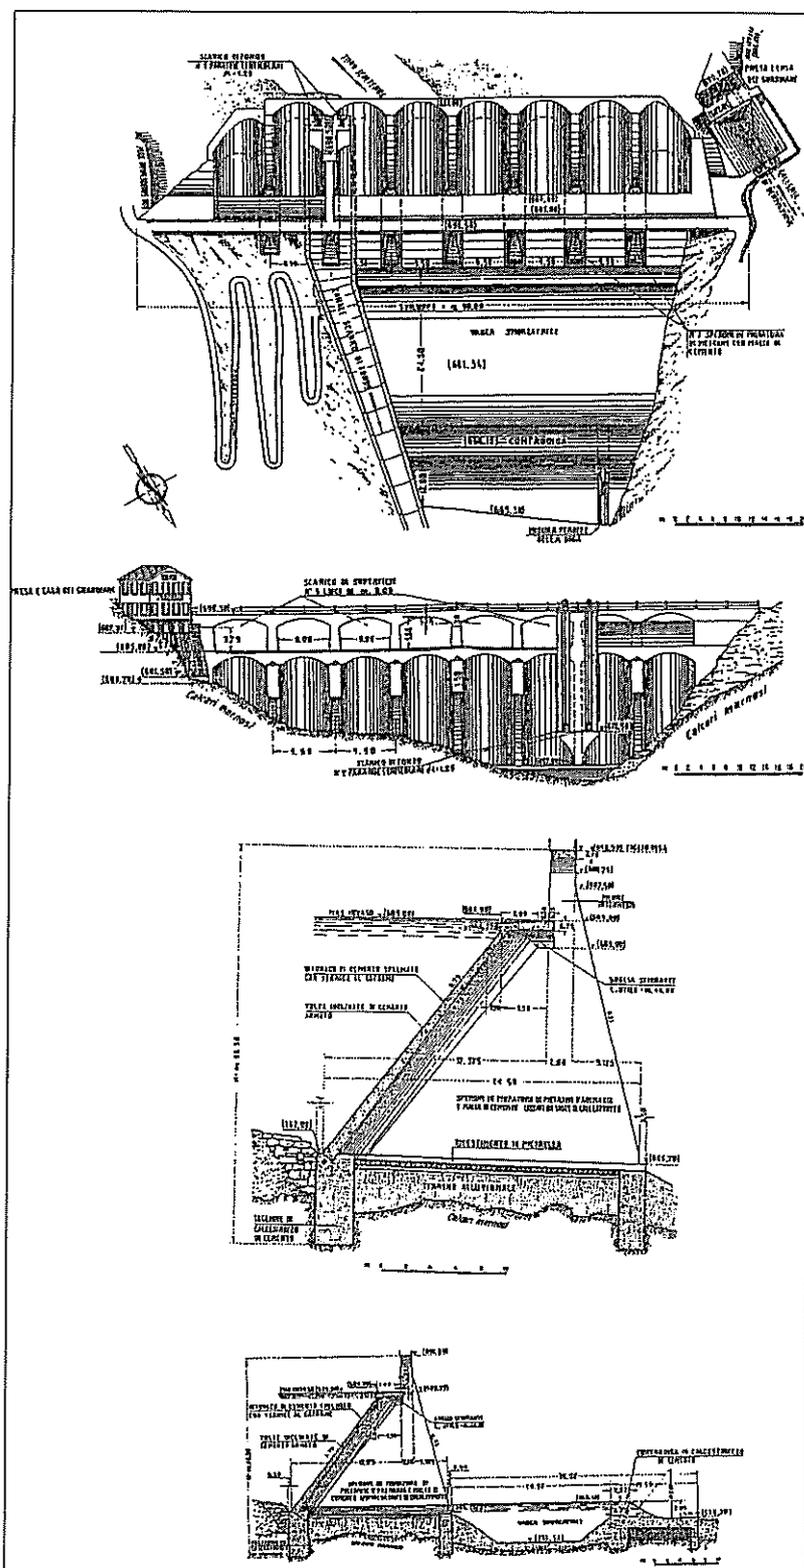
Diga di Riolunato: Planimetria - Vista da monte - Sezione tipo - Sezione sullo sfioratore.
